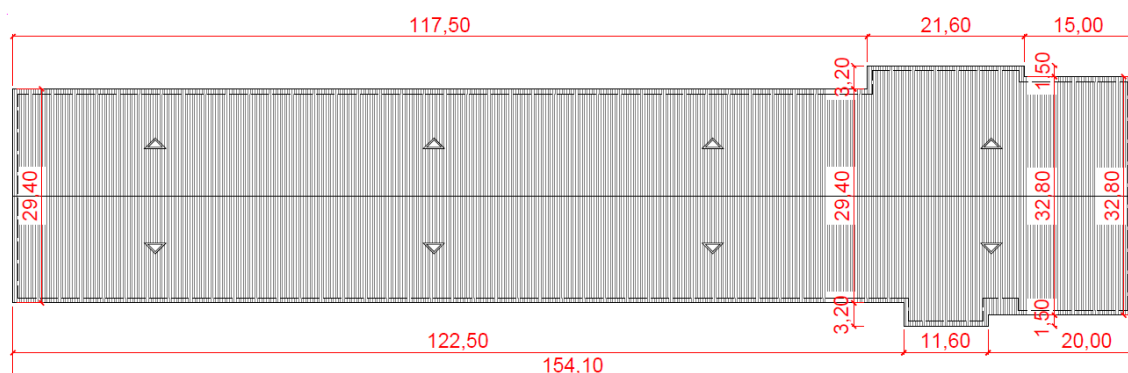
Planta de cobertura da edificação adotada (BRISTOT, 2012).
